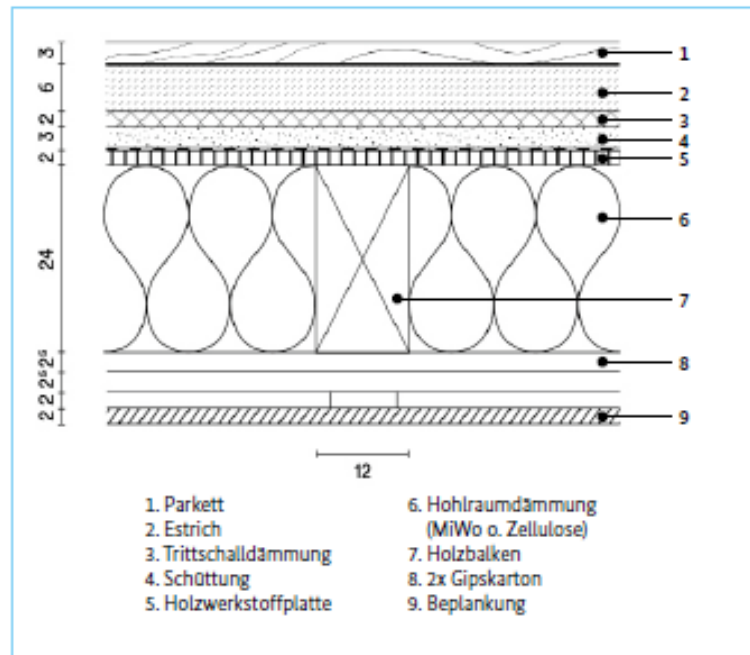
Herkömmliche Bauweise – Holzbau Geschossdecke
